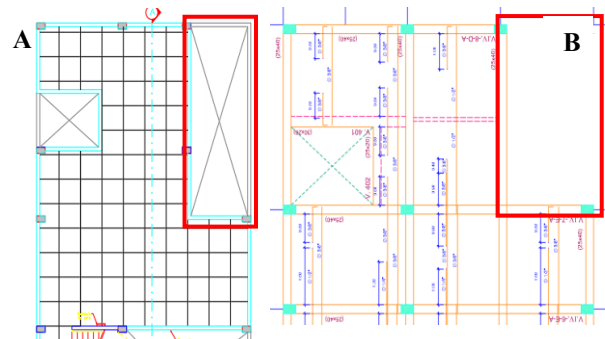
Incoherencias observadas en planos originales. A) Plano de Instalaciones Sanitarias, B) Plano de Losas Aligeradas.
